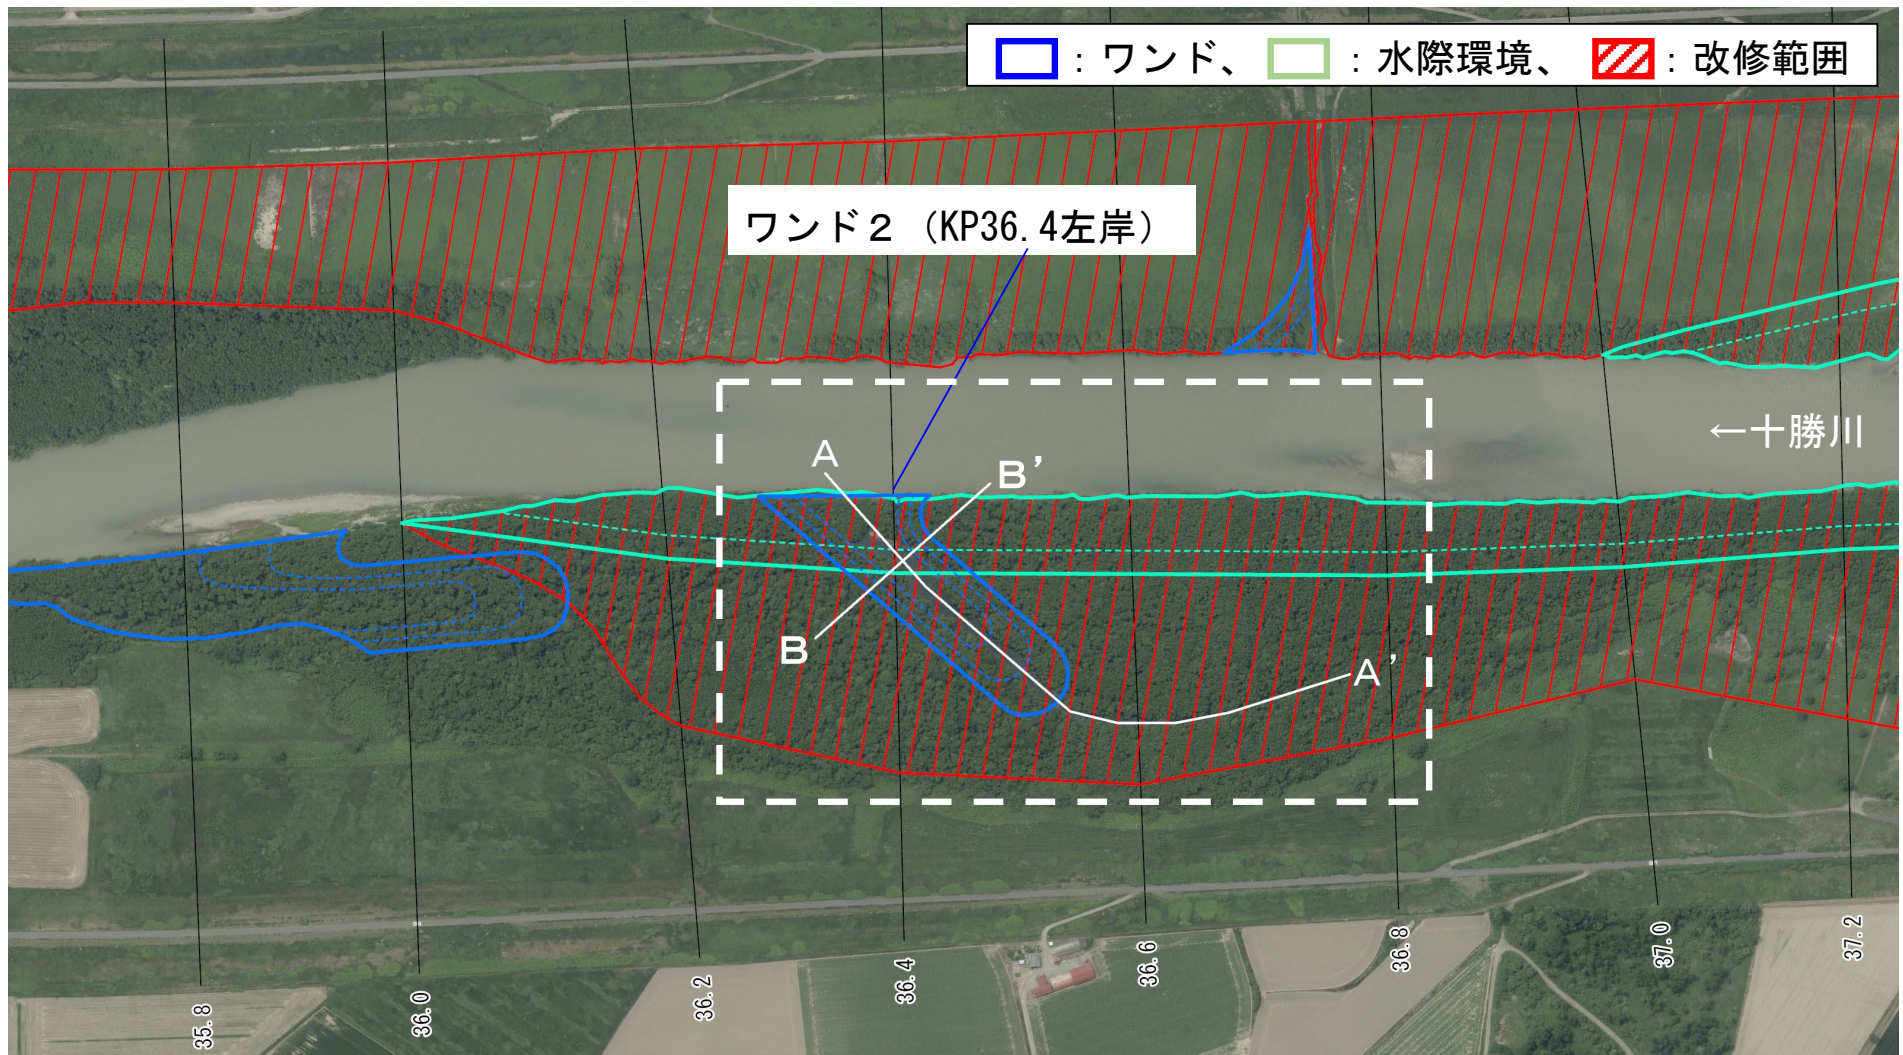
ワンド2 (KP36.4 左岸) の平面配置図
